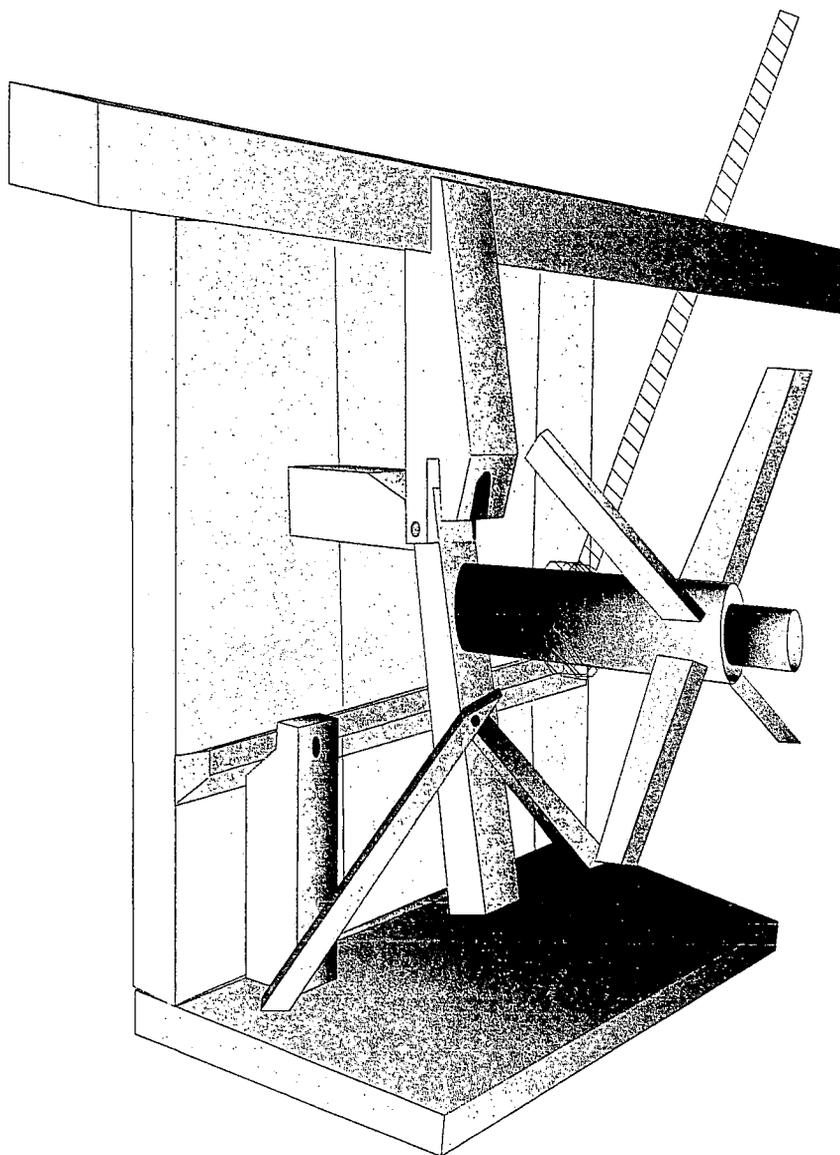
Reconstrucción del ingenio elevador en el reverso del retablo.
